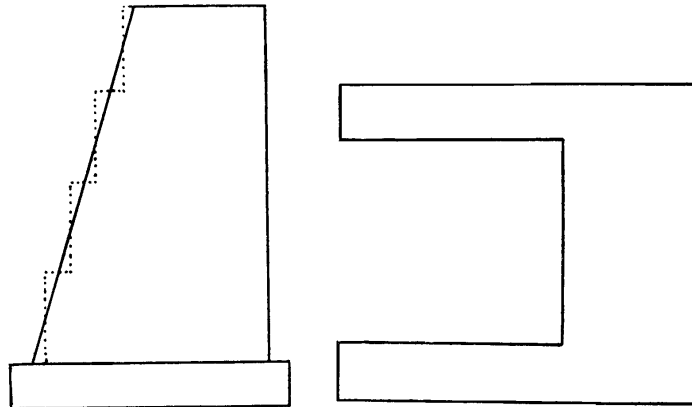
Sezione longitudinale e pianta di una spalla (Campanella,1928).
